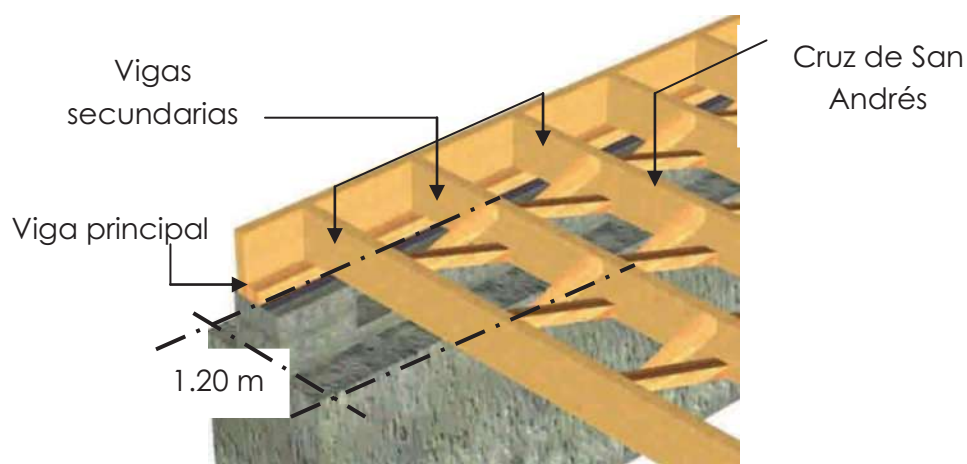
, Crucetas en entramado de entrepiso, Fuente “La Construcción de Viviendas en Madera”, p. 181
